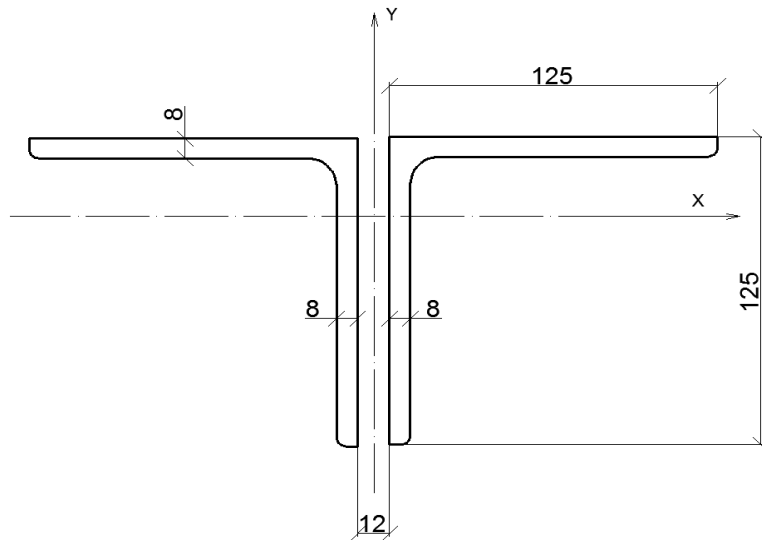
Фактическое поперечное сечение верхнего пояса стропильной фермы
